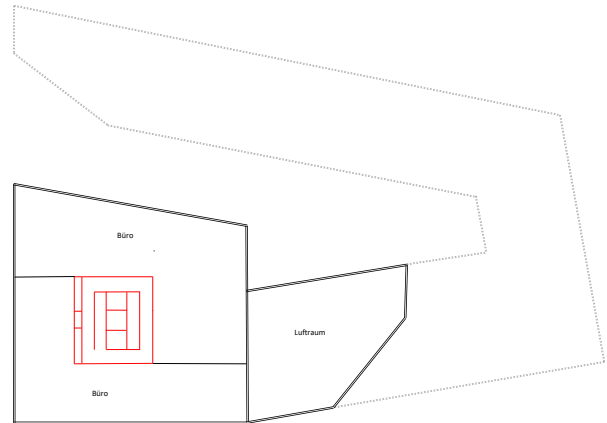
Grundriss Beispiellobjekt - E+8
